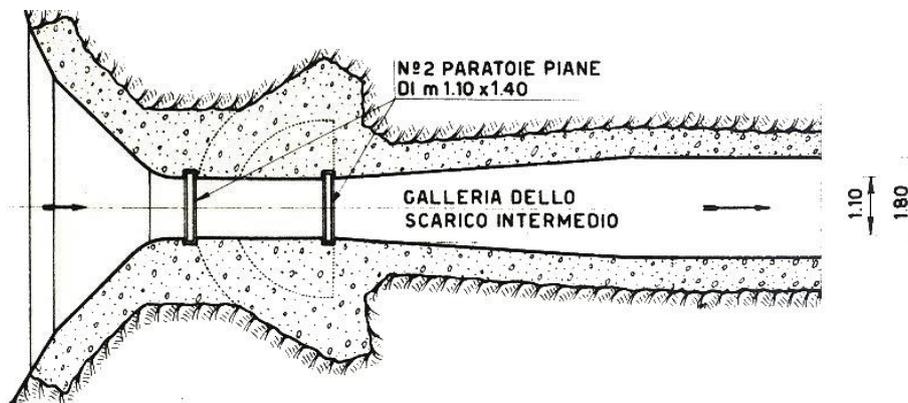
Sezione trasversale imbocco scarico di mezzofondo
